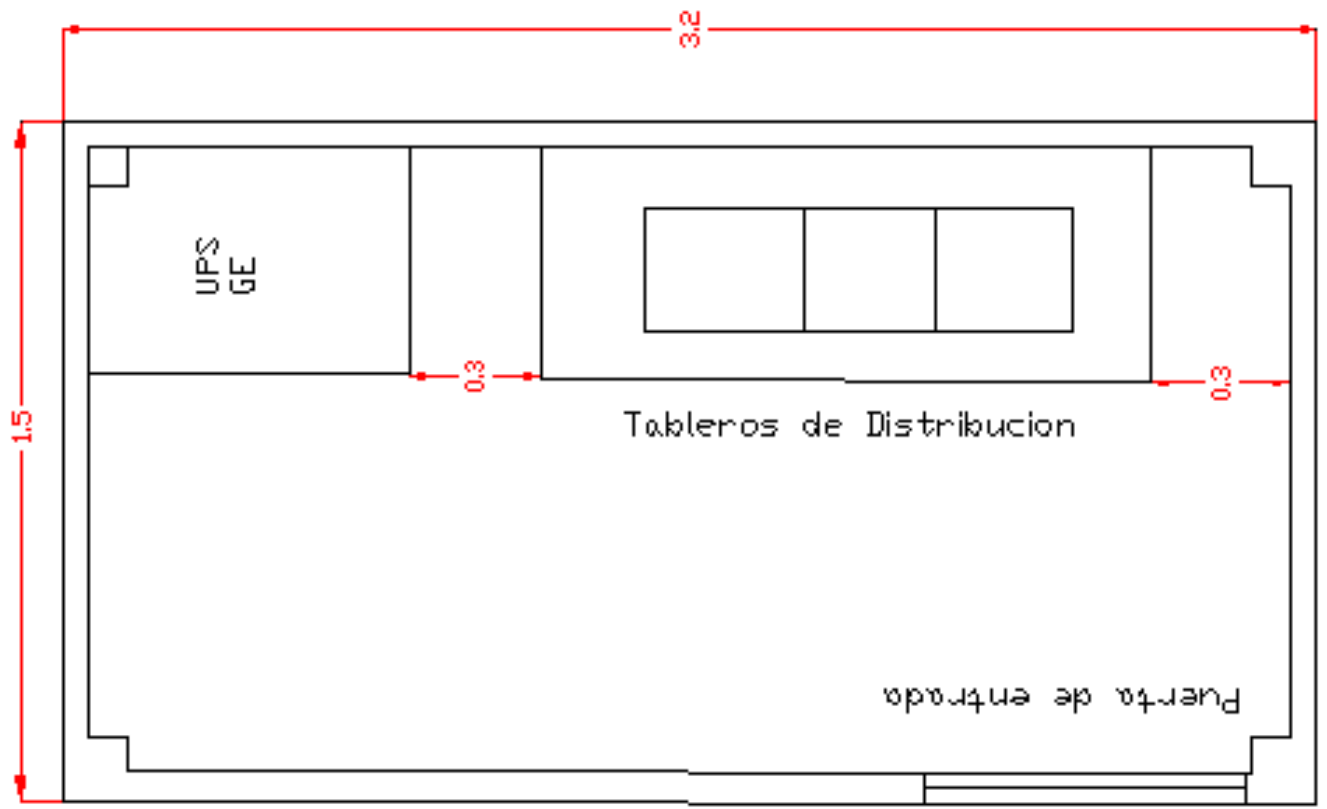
Vista de planta de las dimensiones actuales en subestación eléctrica "C/T 22".
